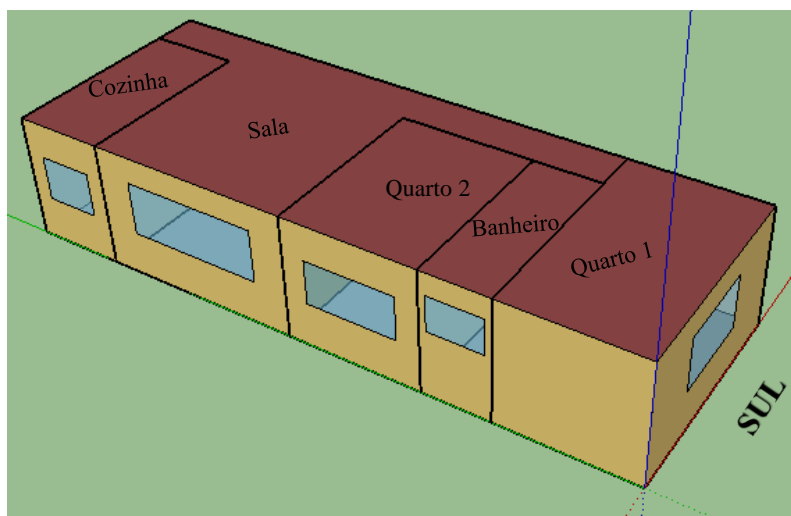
Planta baixa do modelo de edificação multifamiliar.
